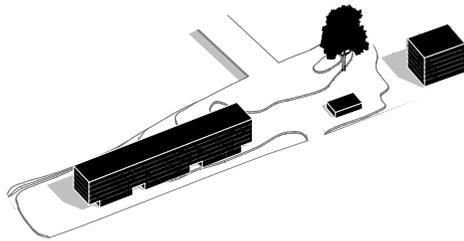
Nachweis Parkierung Reusspark plus Dammgärtli (Vertiefungsvariante 03)
